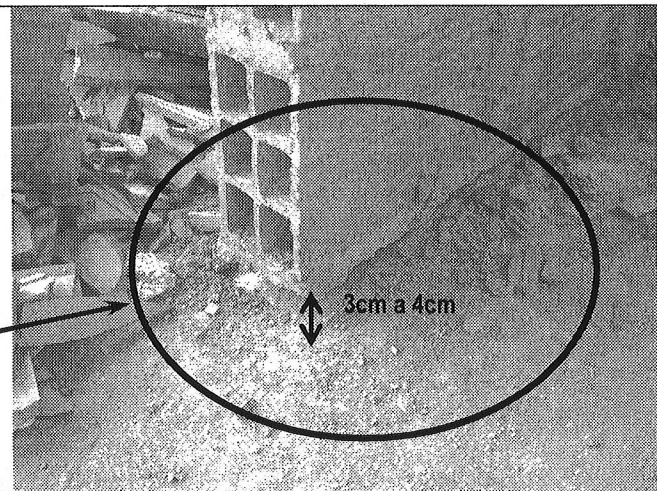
Se observa la separación de aproximadamente 3cm a 4cm.
